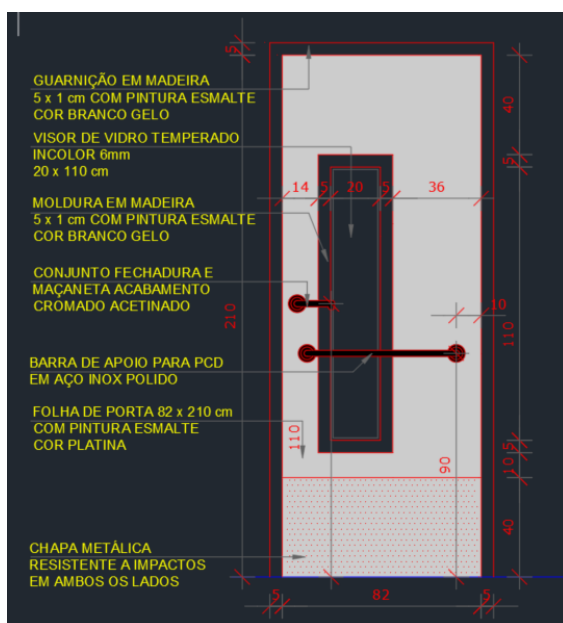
Corte projeto da porta conforme deve ser executado o visor e a barra de apoio.
